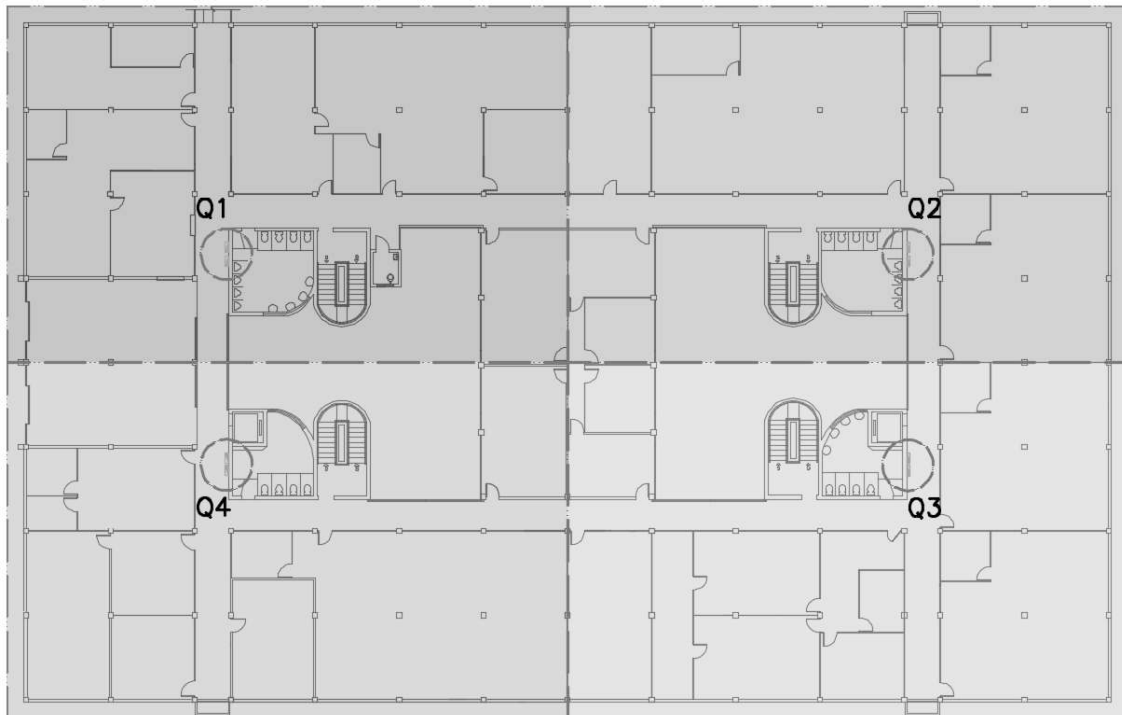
Esquema ilustrando a divisão por quadrantes na planta baixa do primeiro pavimento.
